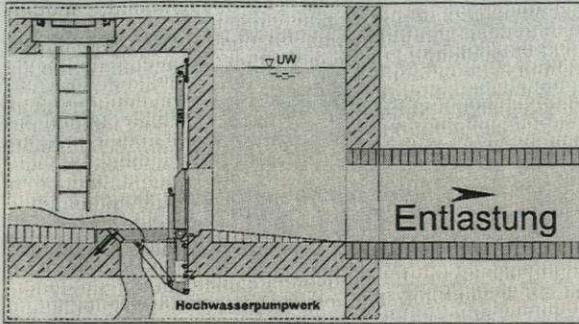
Längsschnitt 2-Wege Rückstau-/Hochwasserklappe
